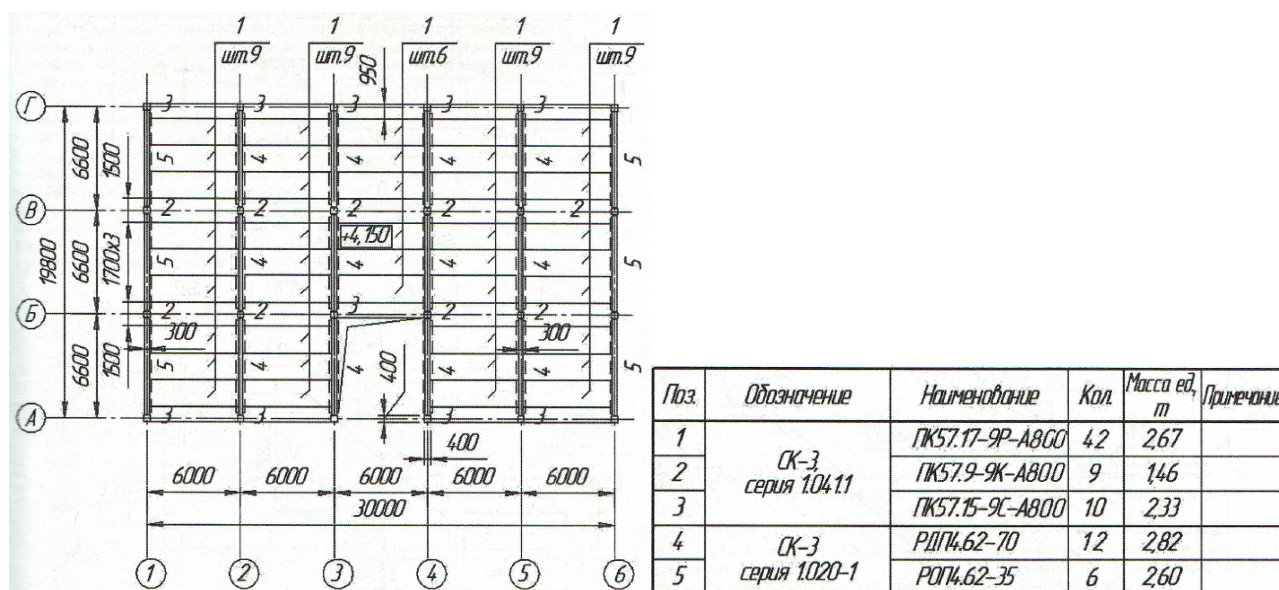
Схема расположения сборных железобетонных элементов перекрытия (отметка +4,150) и спецификация к ней
